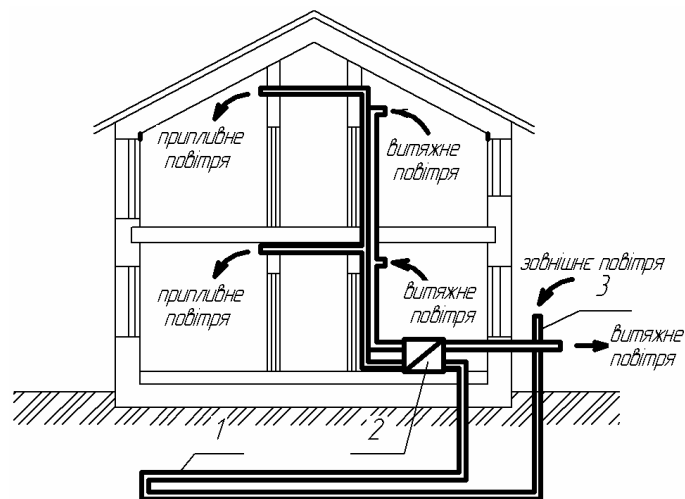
Принципова схема геотермальної вентиляції пасивного будинку
